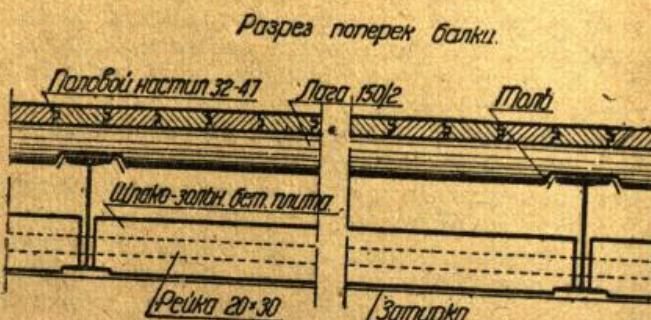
Междуэтажное перекрытие с нижними ксилоцементными плитами.
